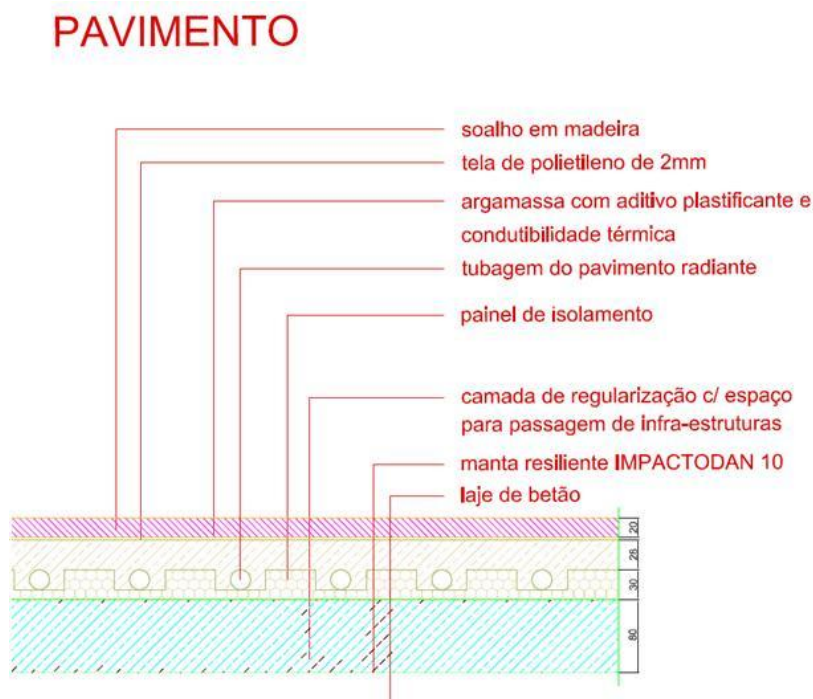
Constituição de pavimento com sistema de aquecimento englobado
